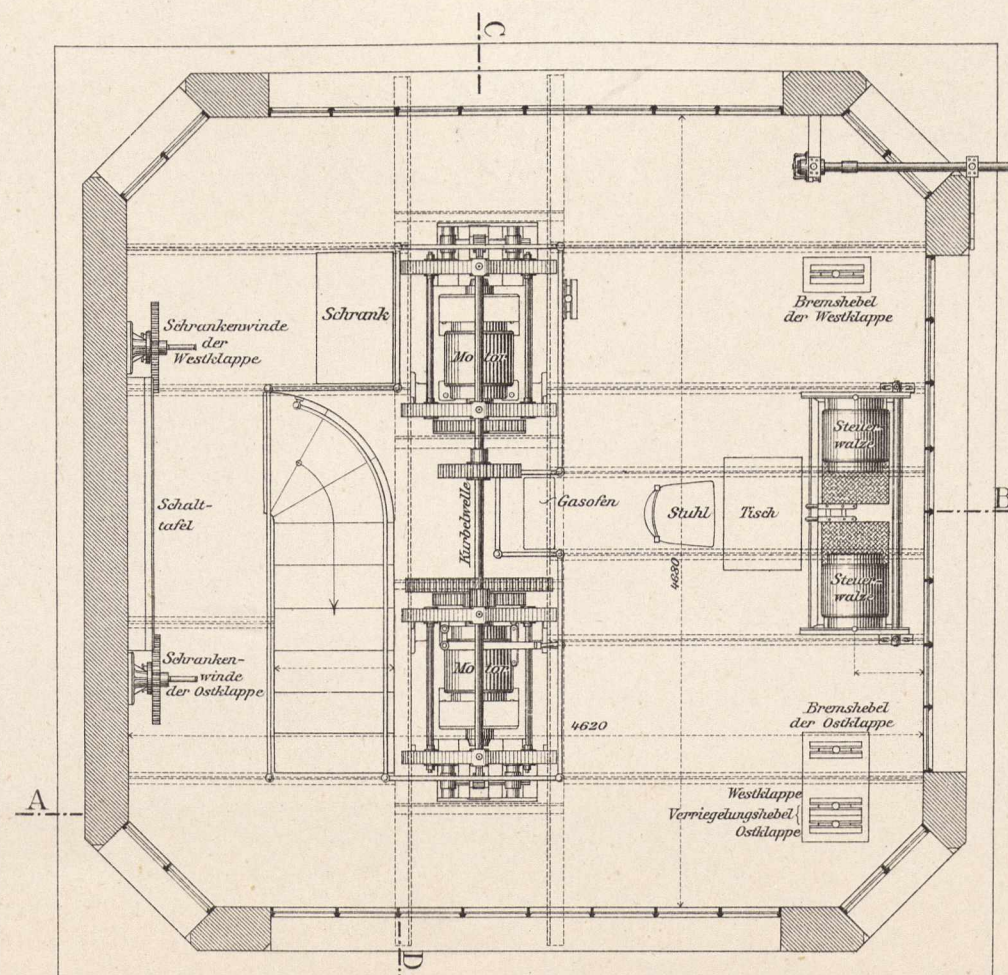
Oberer Grundriß des Maschinenhäuschens auf Duisburger Seite.
